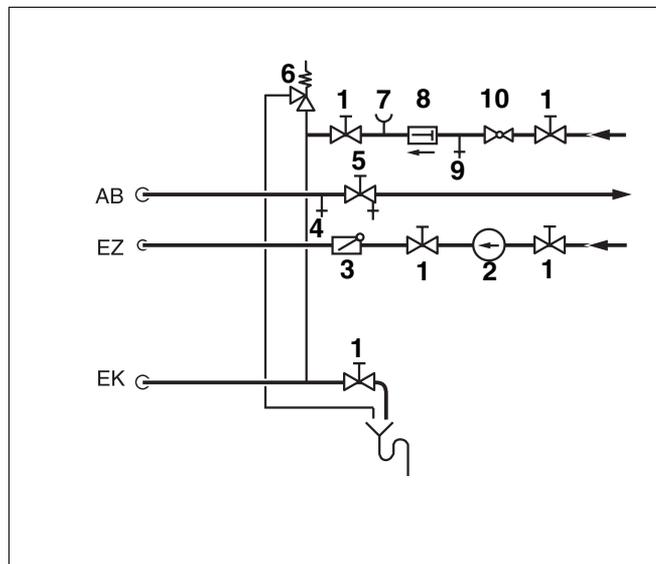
Installation und Ausrüstung der Trinkwasserleitungen
